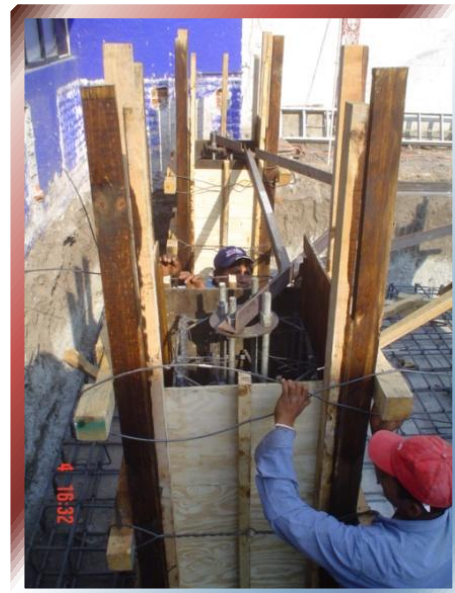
Colocación de tensores de alambón en cimbra.
